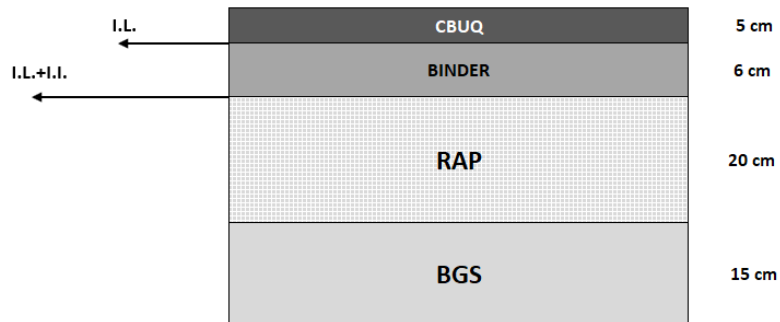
Esquemática da estrutura do Pavimento Tipo 1 – Flexível.
